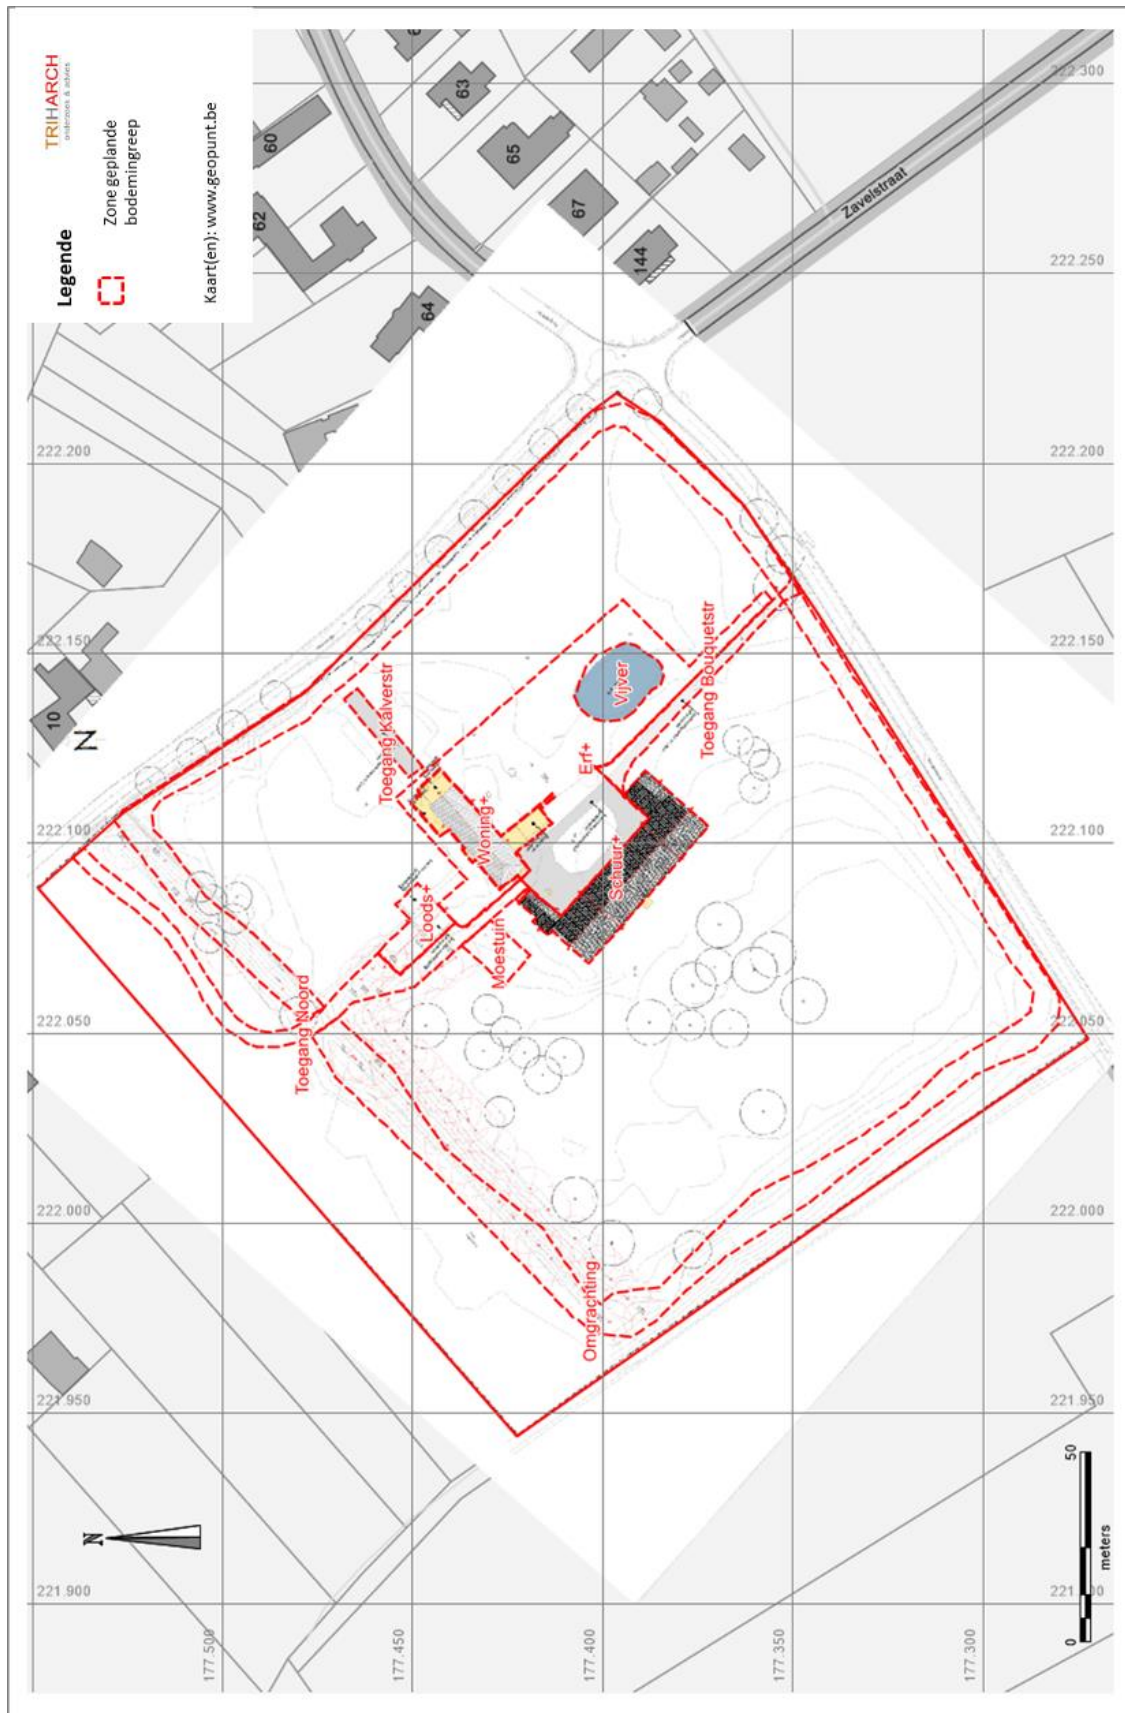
Inplantingsplan van de nieuwe toestand met aanduiding van de terreindoorsneden, te verwijderen verhardingen en de te slopen gebouwen, bijgebouwen en constructies. (Bron: vergunningsaanvraag)
